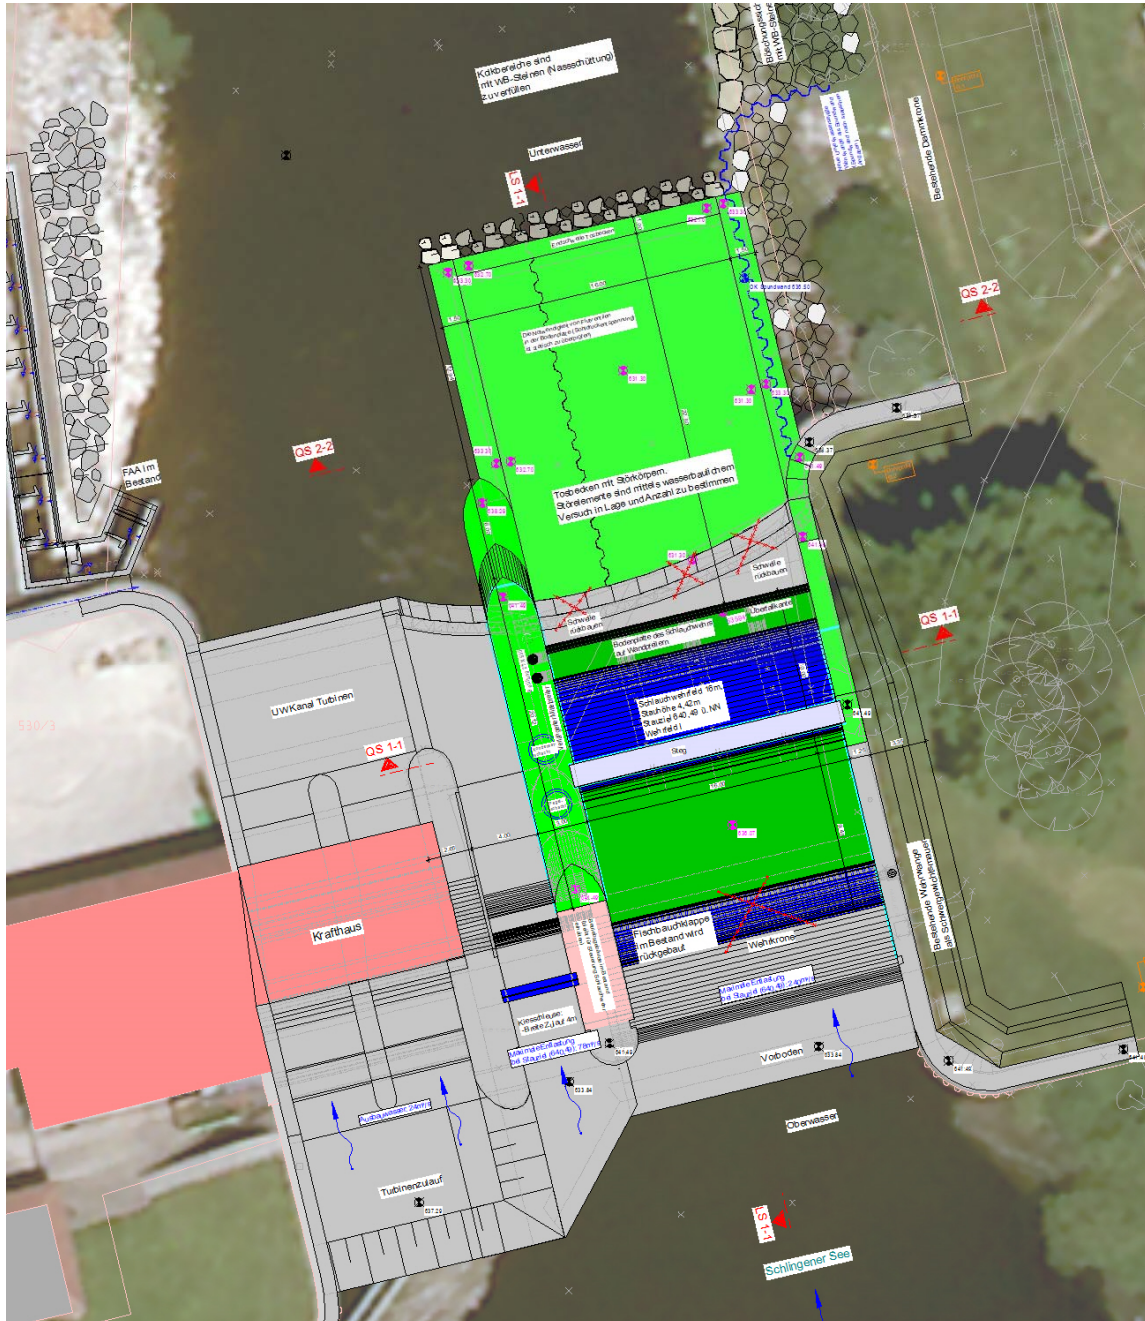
Draufsicht – Sanierung Hochwasserentlastung I
